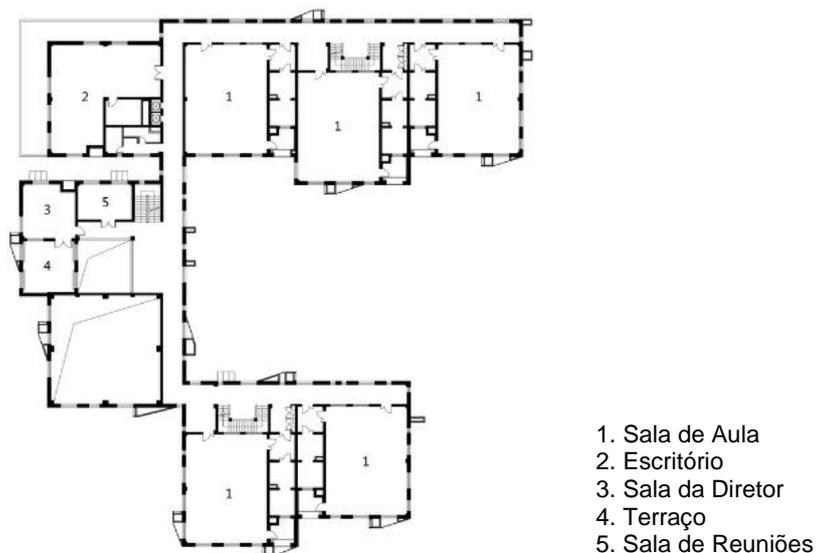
Planta Baixa Piso 1 "O paraíso da cor"
